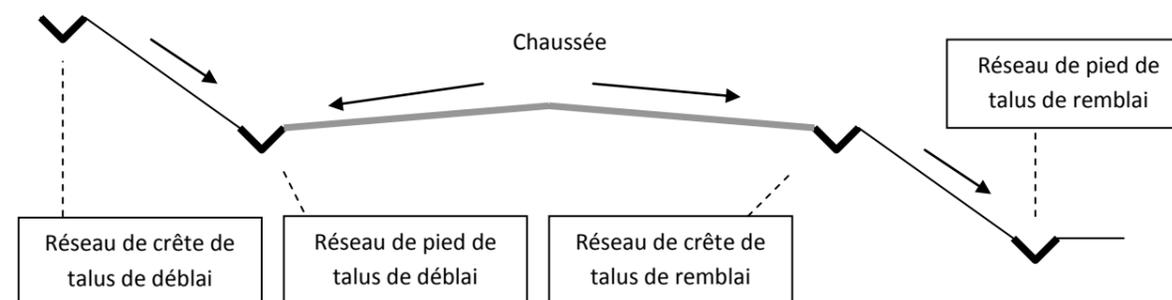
Schéma des différentes implantations des ouvrages de collecte des eaux pluviales
